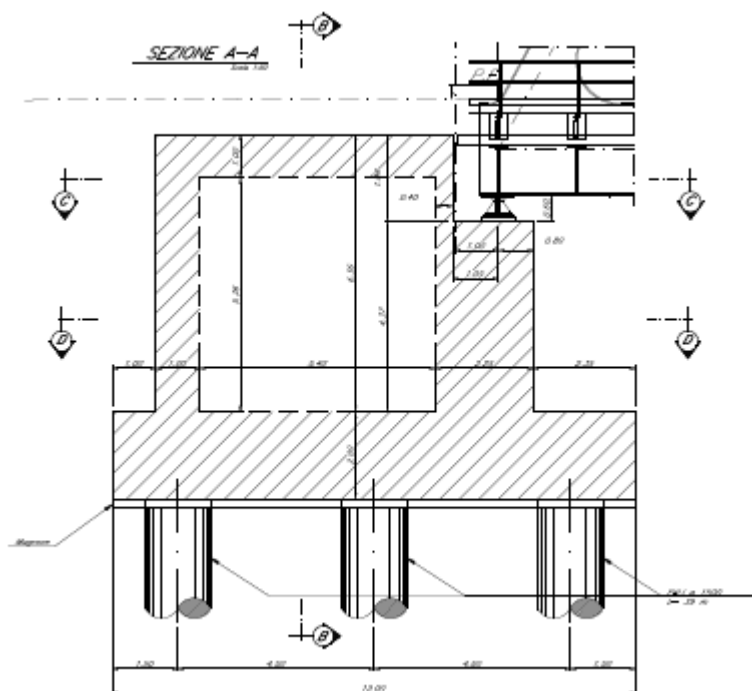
Sezione A-A spalla Ponte sul Naviglio Pavese
